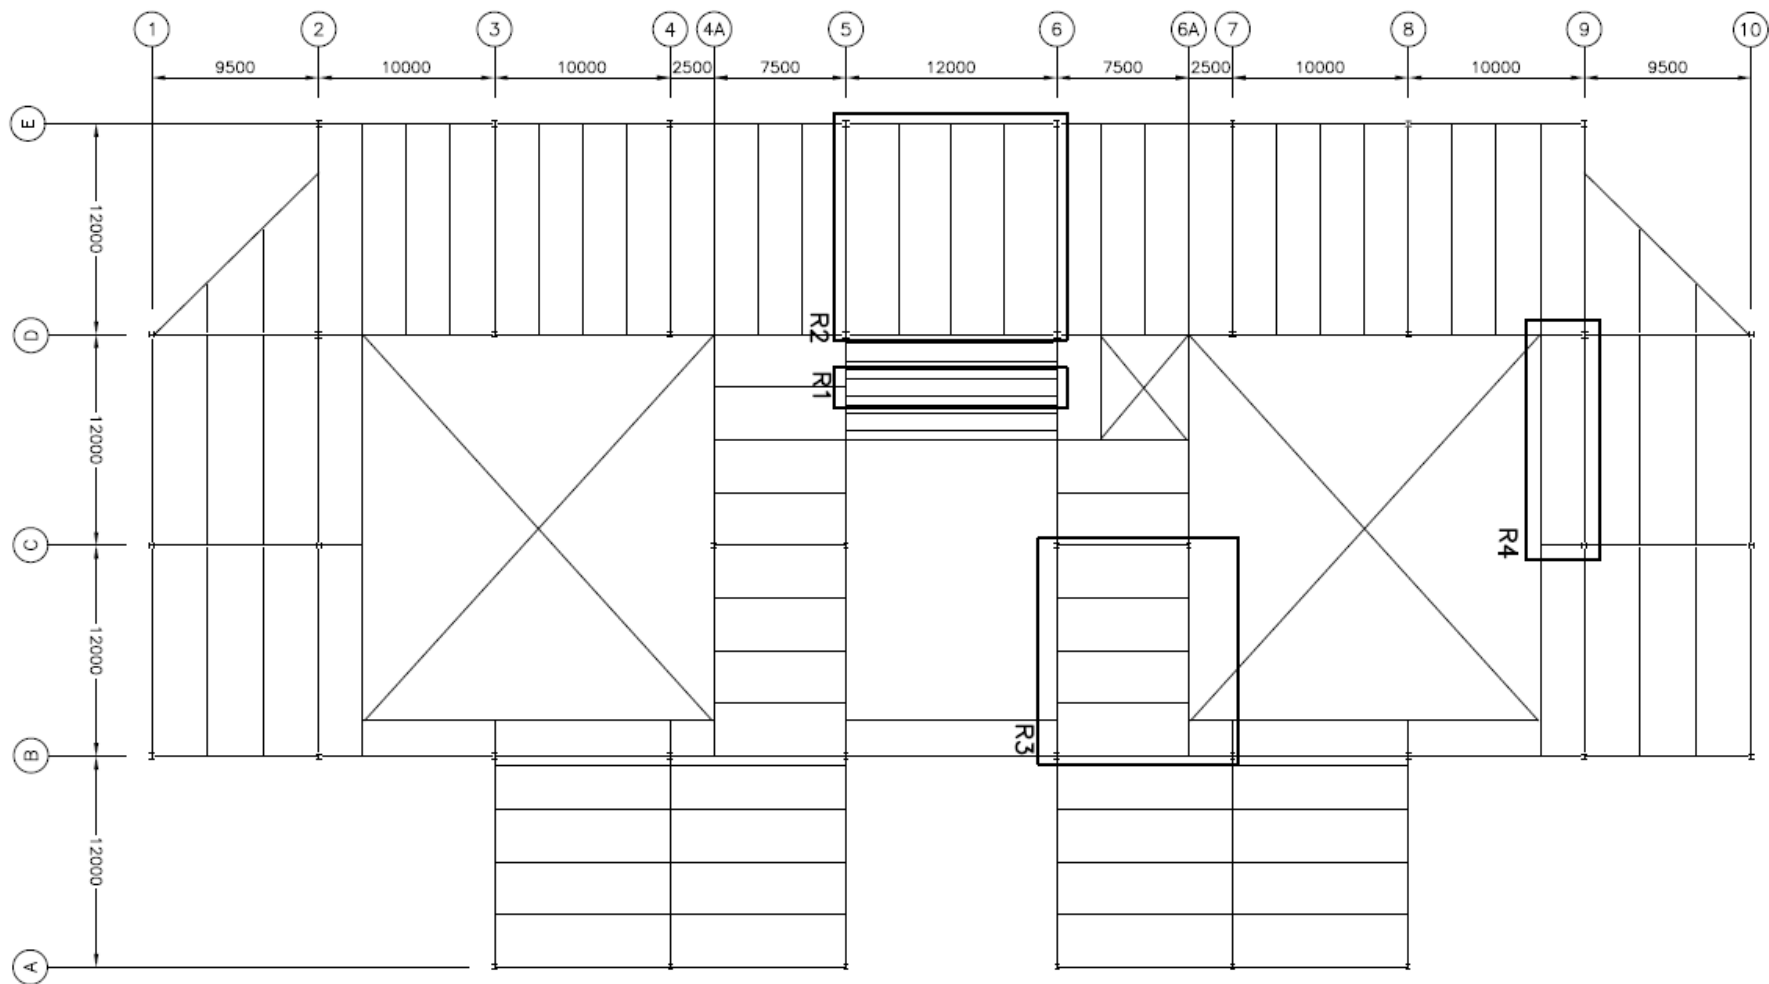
Plano das vigas do segundo pavimento com a demarcação das regiões críticas selecionadas.
